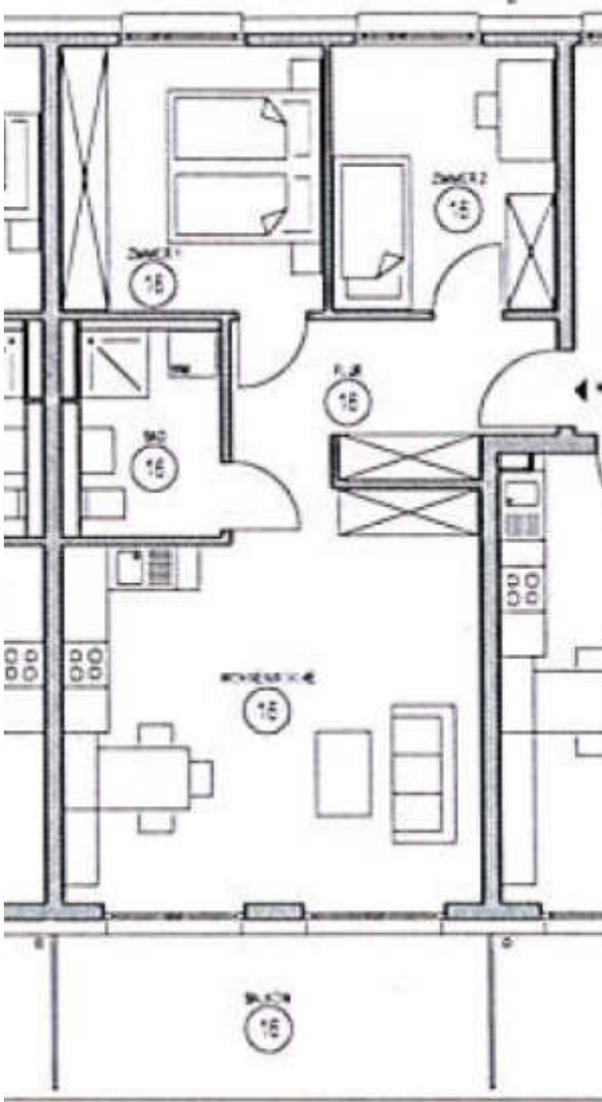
Grundriss Wohnung Nr. 16 (Ausschnitt ohne Maßstab); Quelle: Anlage 1 zur Urkunde 303/2021/ Teilungserklärung vom 10.02.2021
